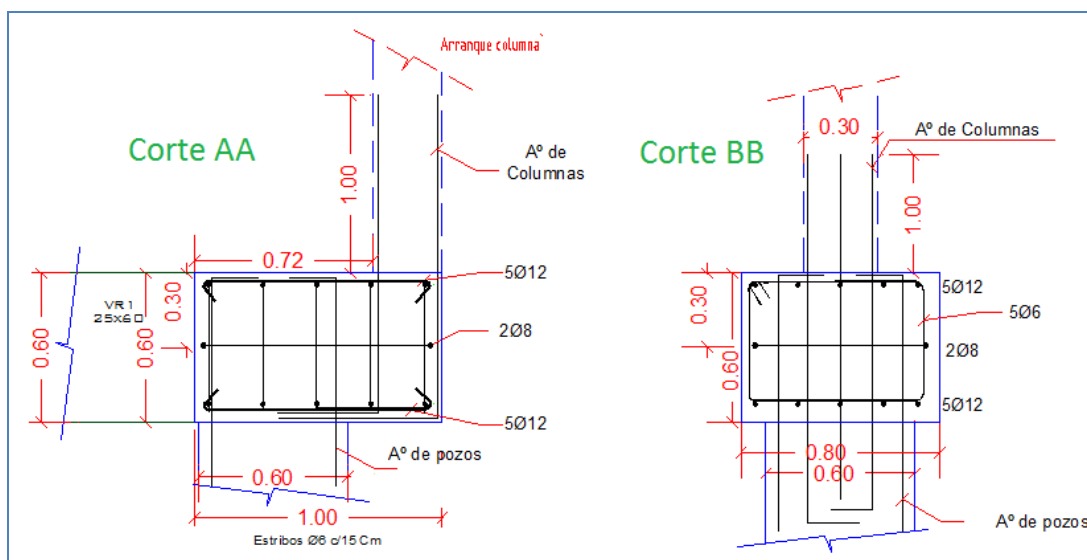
Detalle del cabezal Cbz 5. Corte AA y BB.
